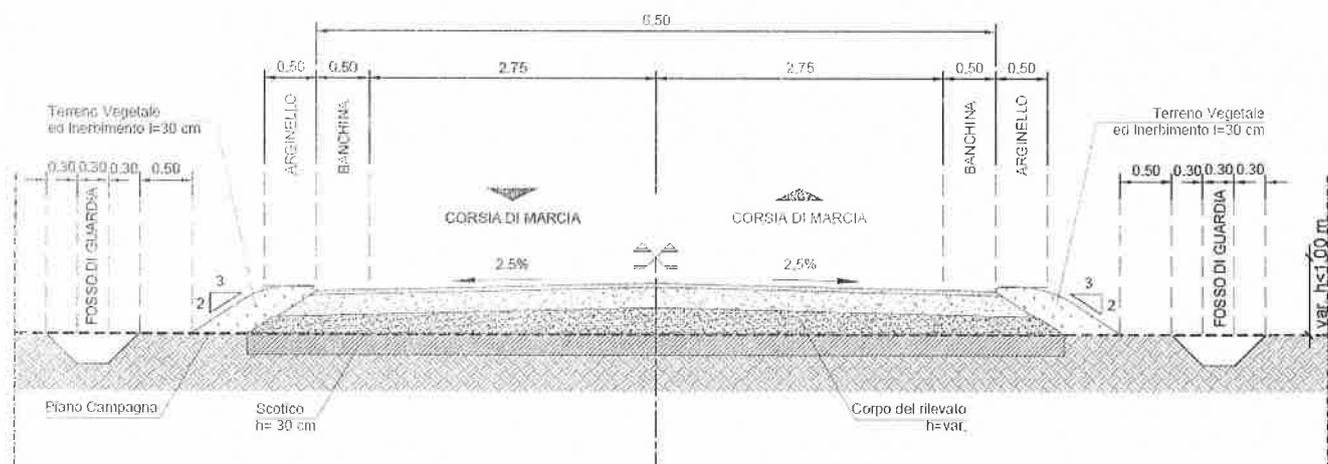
Sezione Tipo in Rilevato $h < 1,00$ m
